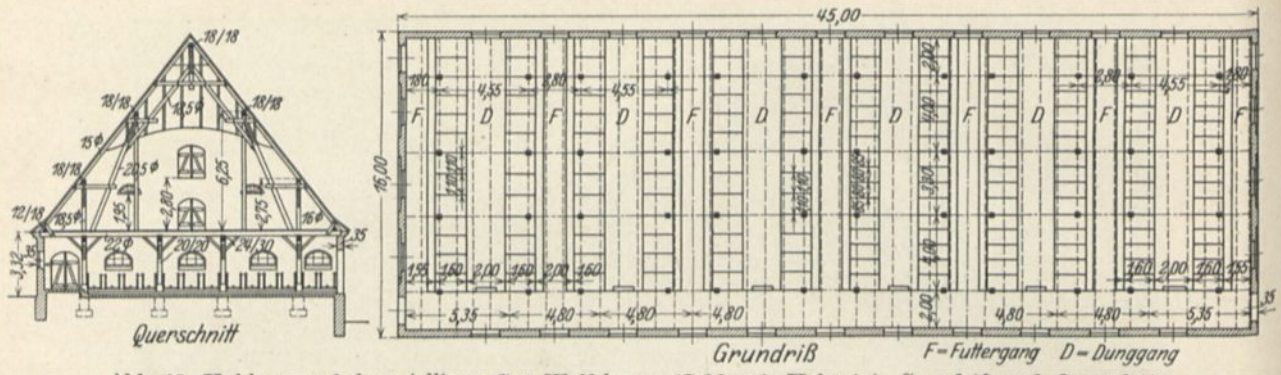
Kuhhaus auf dem Adligen Gut Wulfshagen (Schleswig-Holstein). Grundriß und Querschnitt durch Stall und Futterboden.
